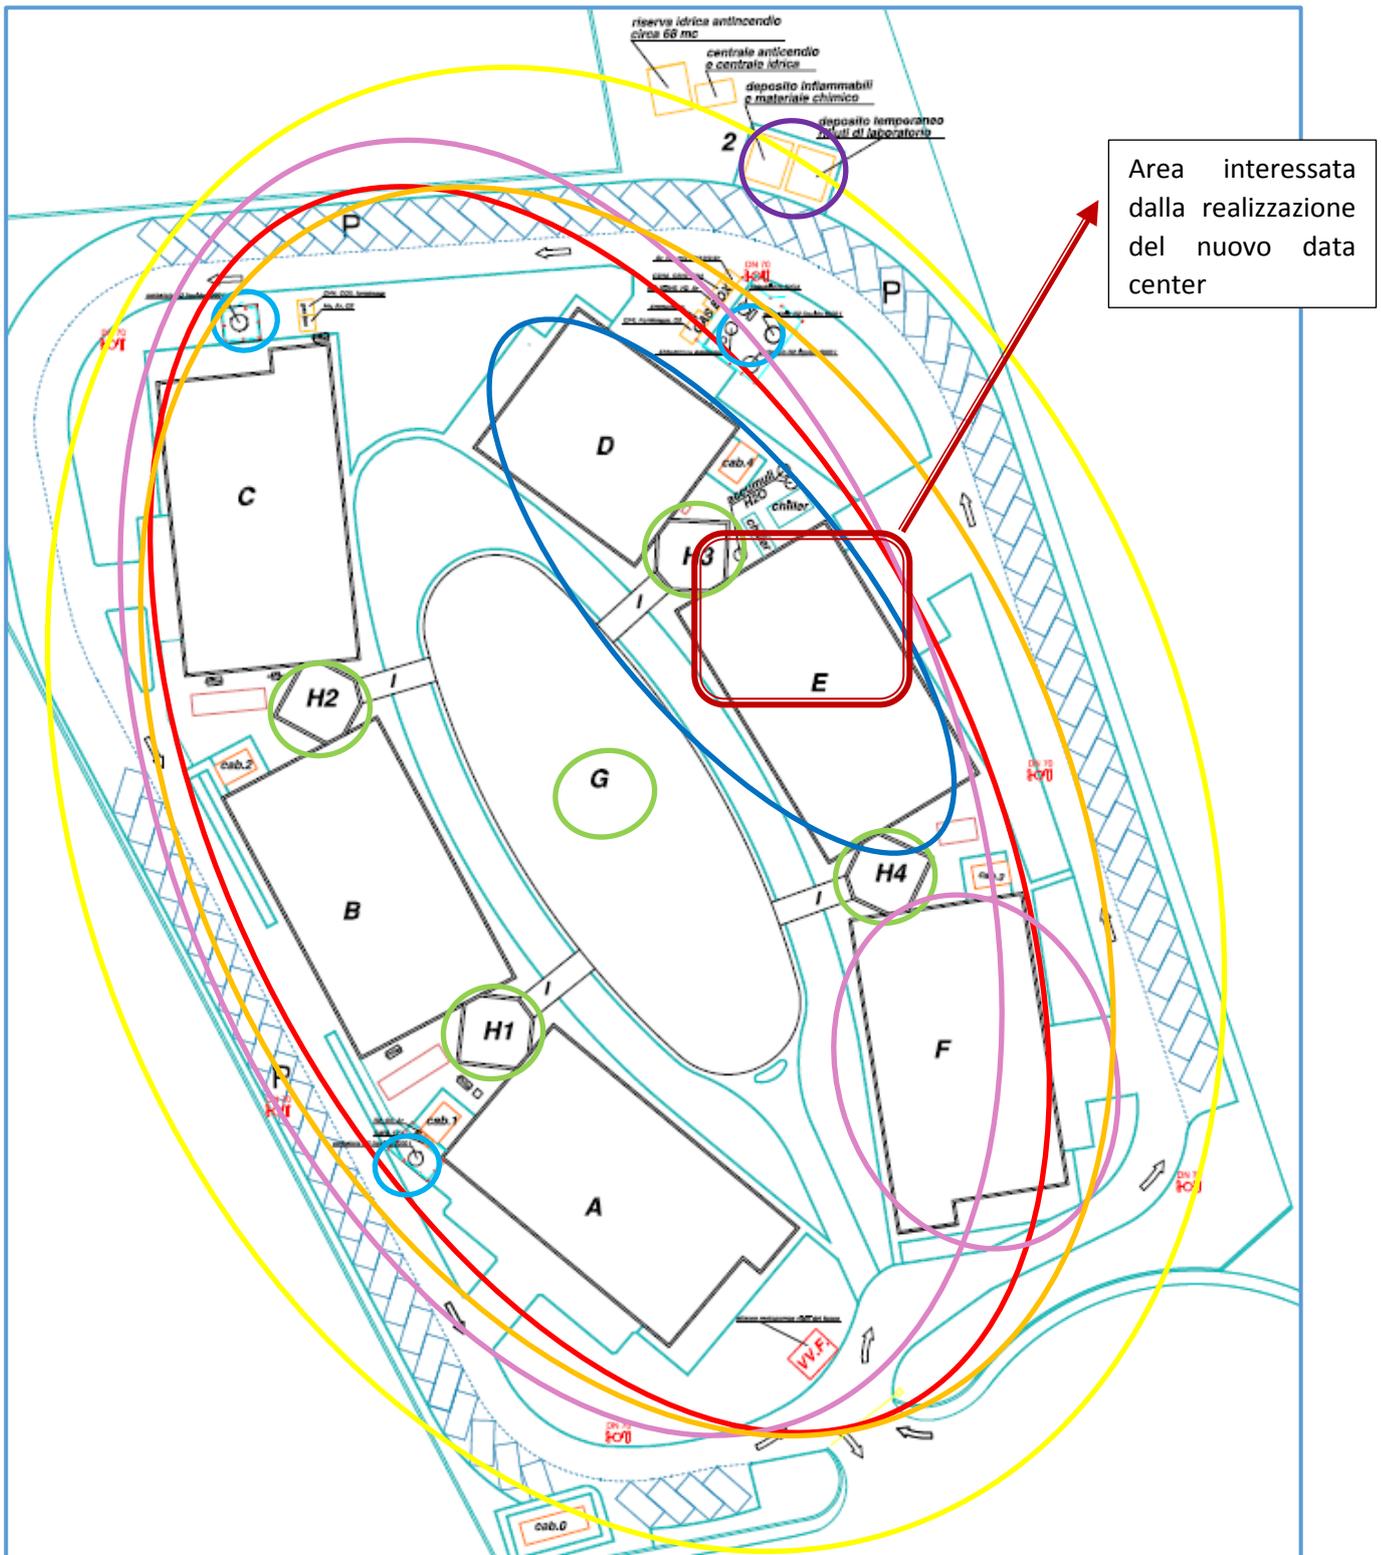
planimetria generale riportante le aree interessate dalle varie ditte di manutenzione con aggiunta dell'attività oggetto del seguente appalto.
